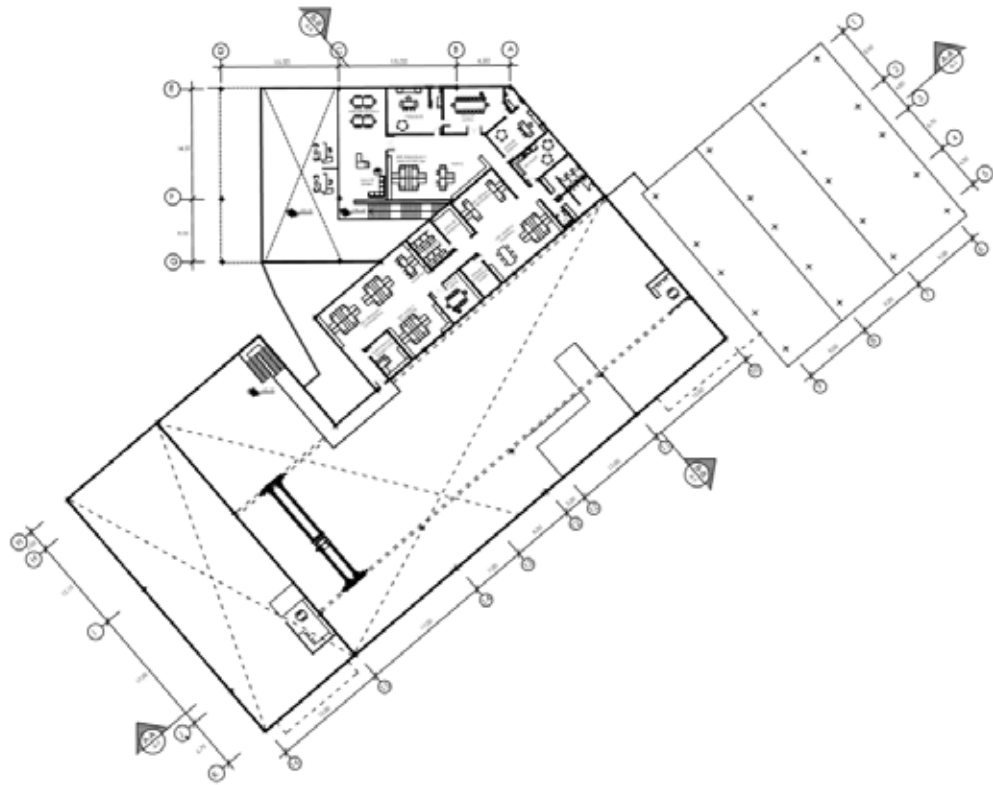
Planta Alta. Autora: Nathalie Colmenares. (2019)
